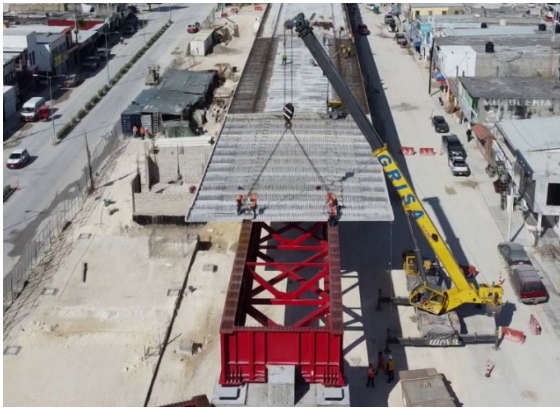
Colocación de losas superiores de hormigón prefabricado.
